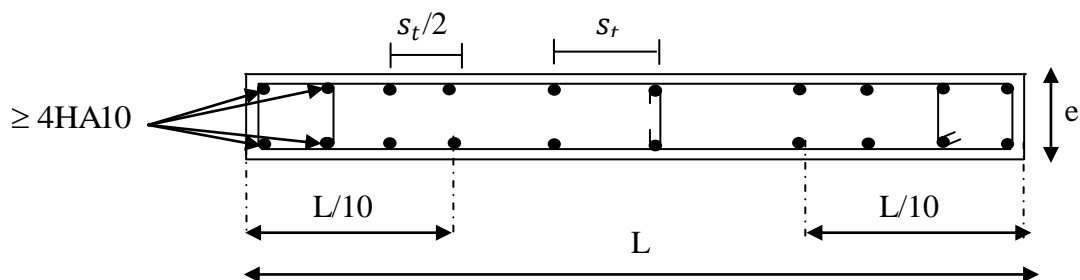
Disposition des armatures verticales dans les voiles.
